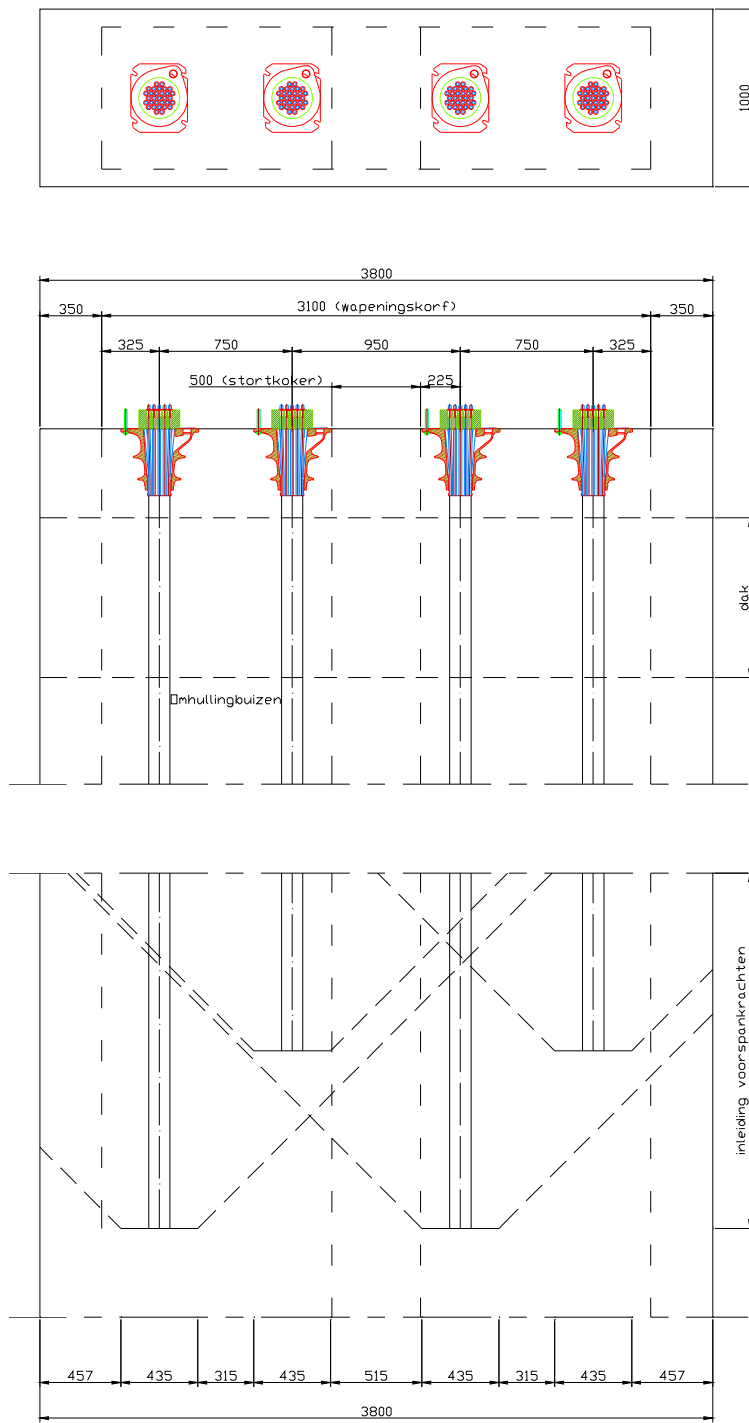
Detaillering van voorspanning in diepwanden
